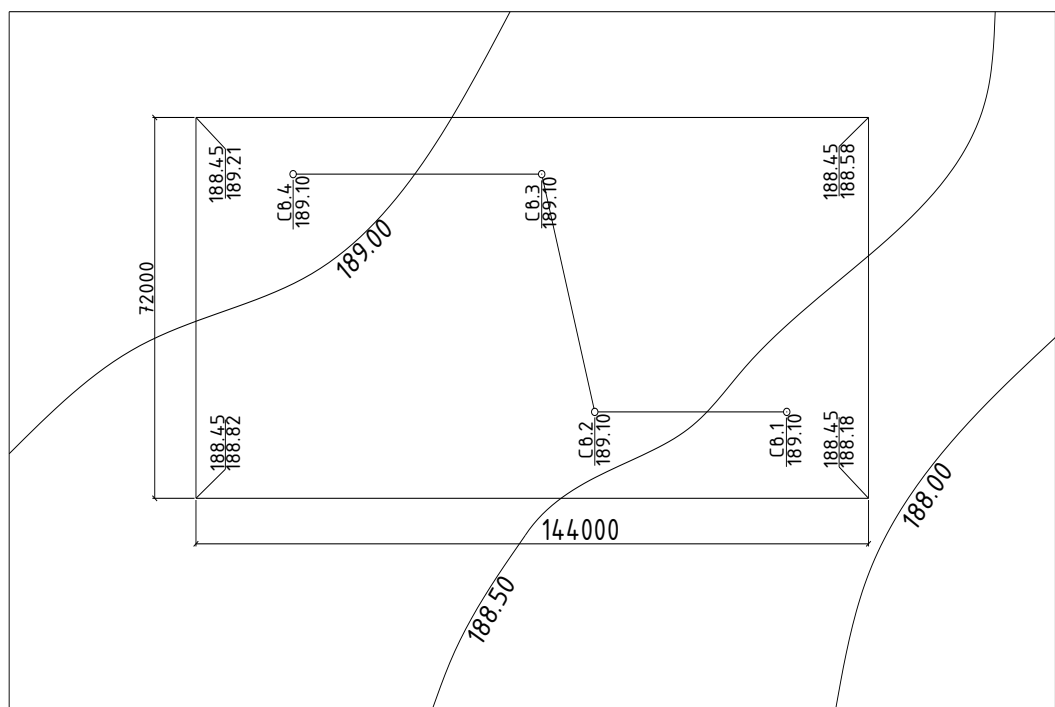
Схема розміщення свердловин на будівельному майданчику [41]
